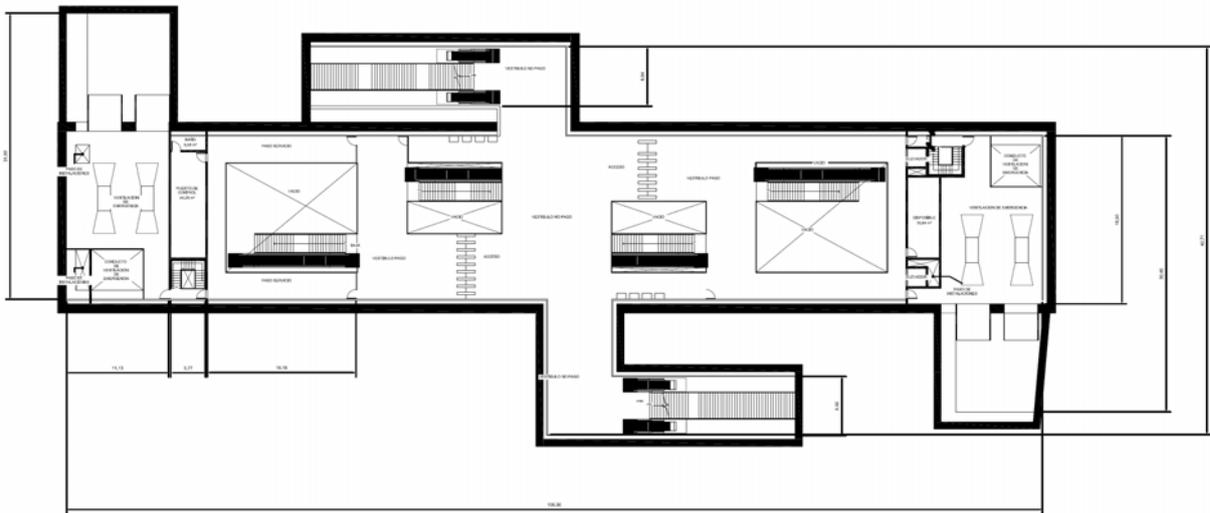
Planta nivel vestíbulo para estación tipo subterránea
